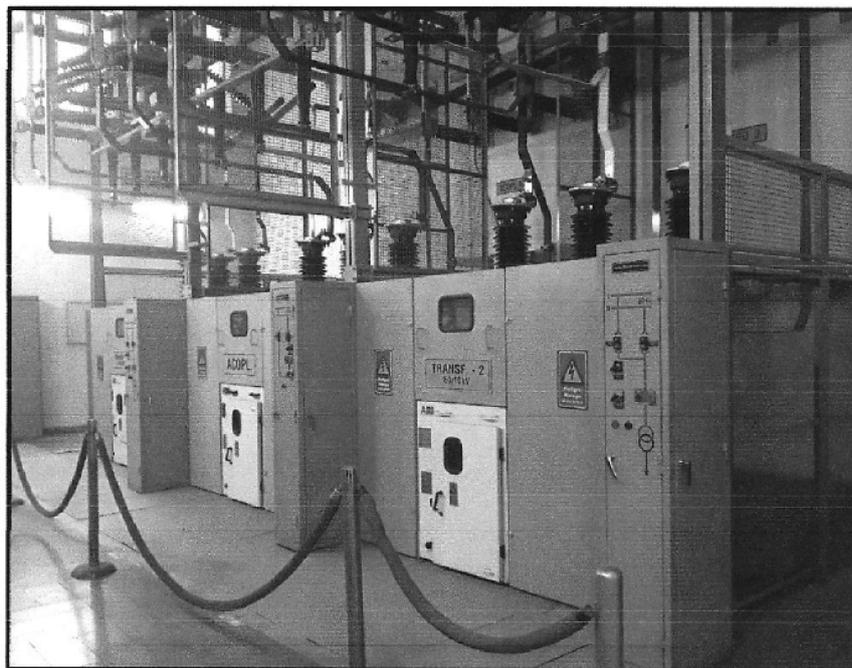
Vista a detalle del área del transformador (piso pavimentado)
